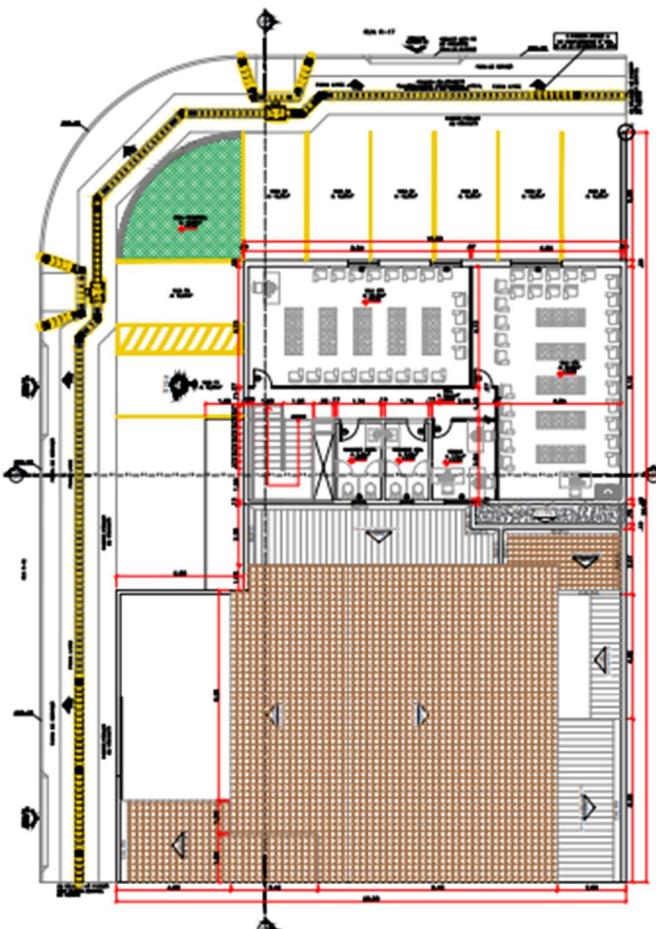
Planta Situação do Empreendimento. Adaptação: Lopam Engenharia, 2023.
